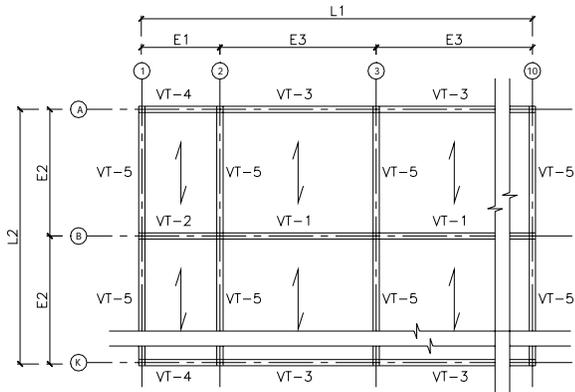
Codificación de vigas de techo o azotea Modulación unidireccional (rectangular)
